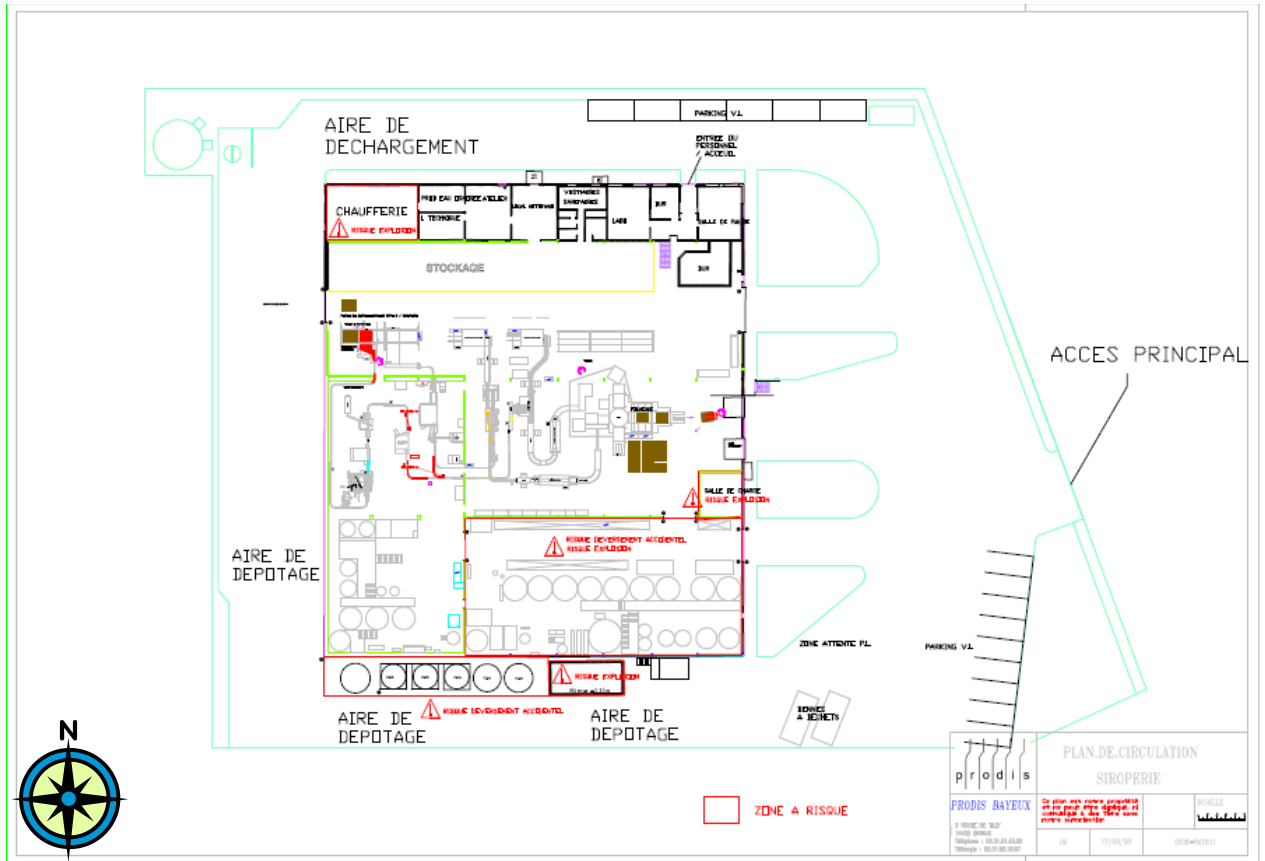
Plan masse de l'usine (source : MAISON JOHANES BOUBEE) - sans échelle
